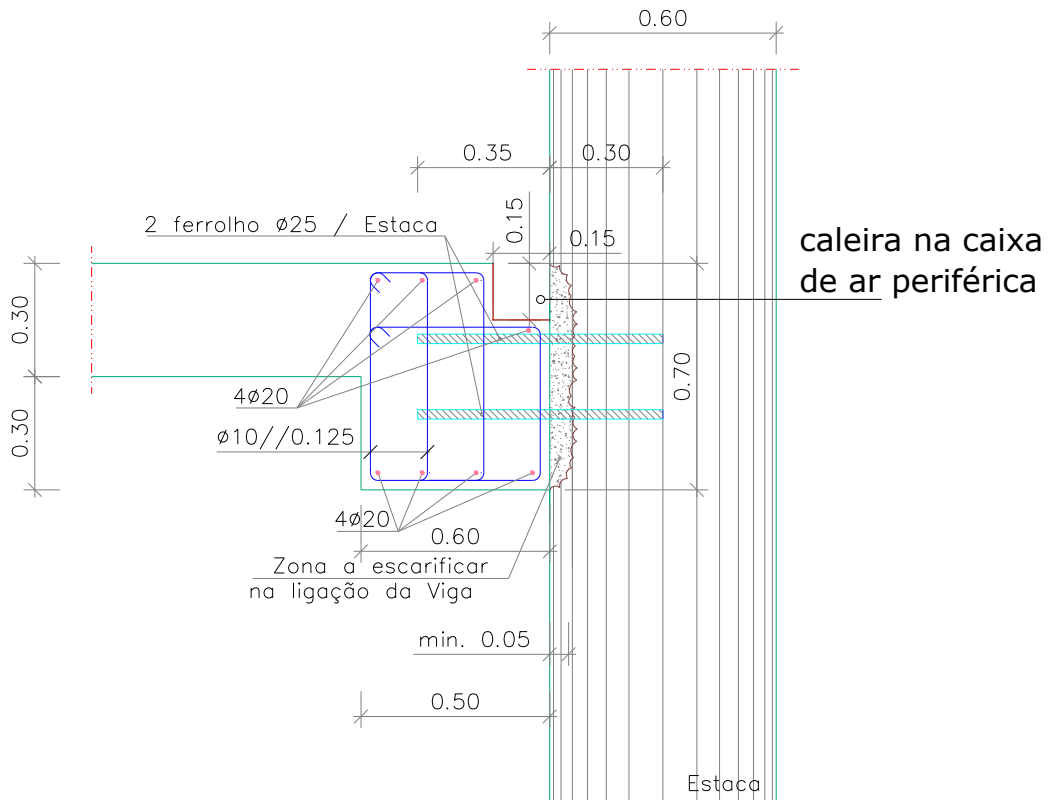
Pormenor final de ligação da laje à cortina de estacas no piso -2.
